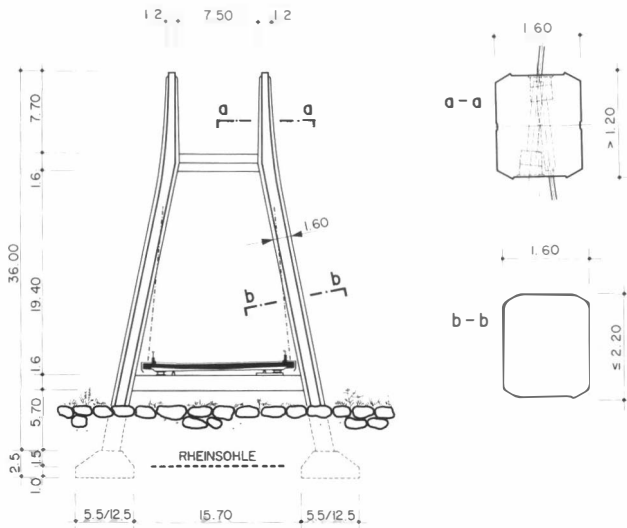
Betonpylon. Ansicht und Querschnitte – Pylône en béton. Plan vertical et sections transversales – Concrete pylon. View and cross sections
